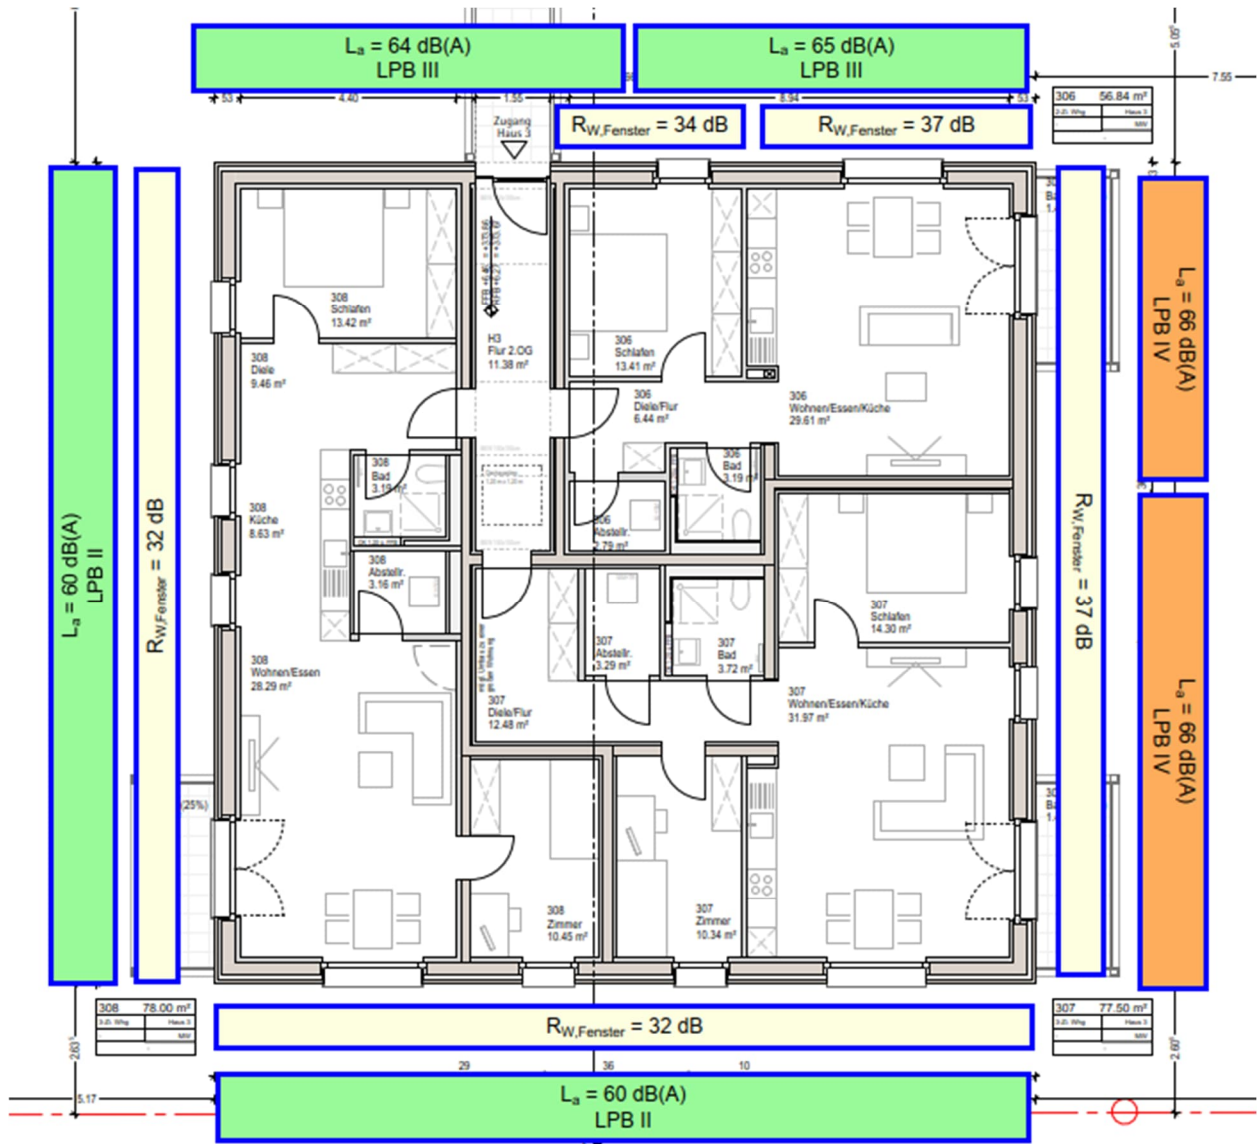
Außenlärm – Grundriss 2.OG – Haus 3
